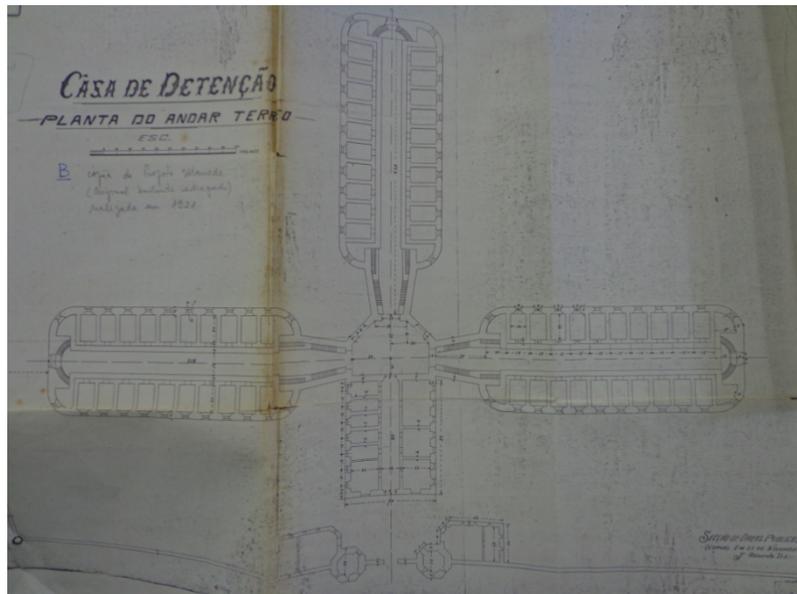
cópia da planta baixa Casa de Detenção do Recife - Projeto Mamede Ferreira.
